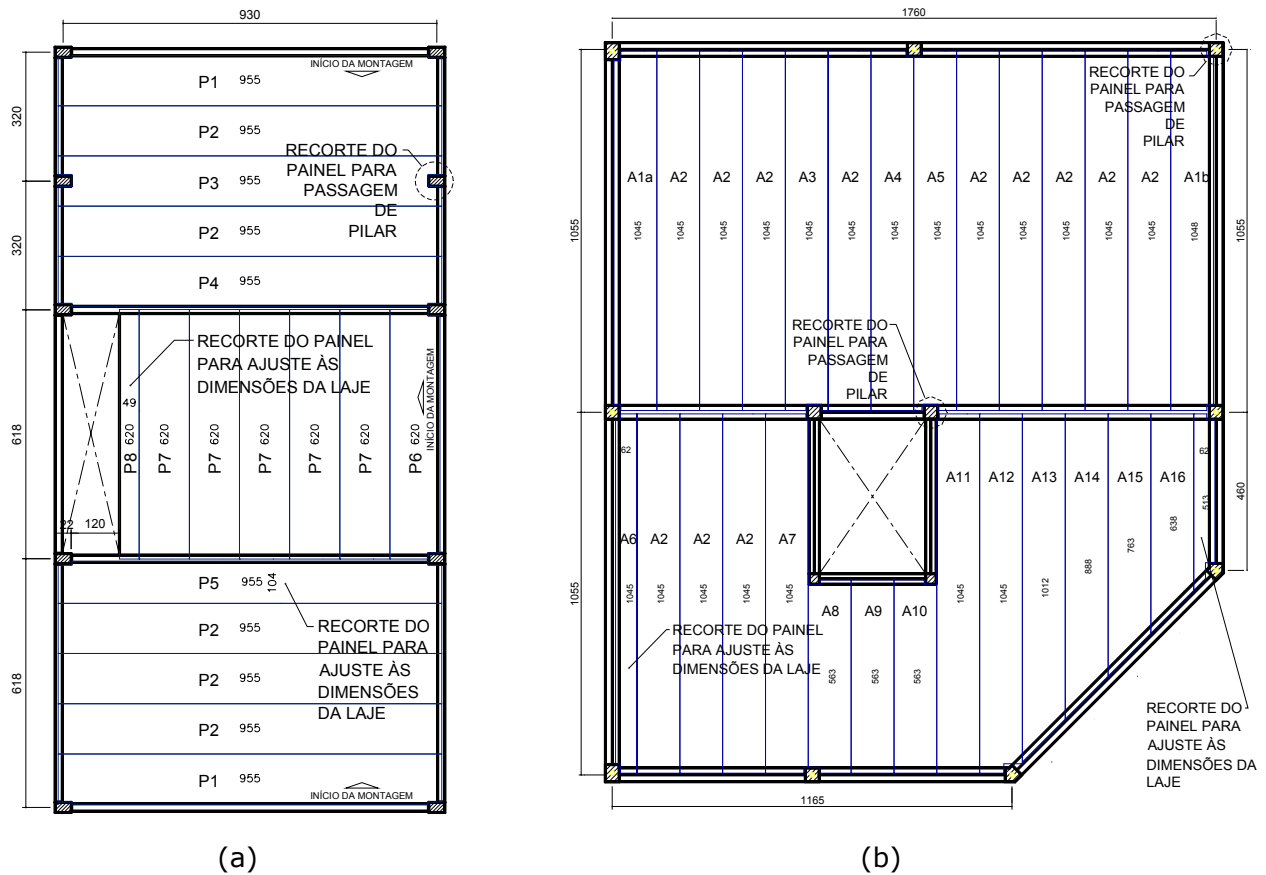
Modulação das lajes alveolares com indicação das placas recortadas
